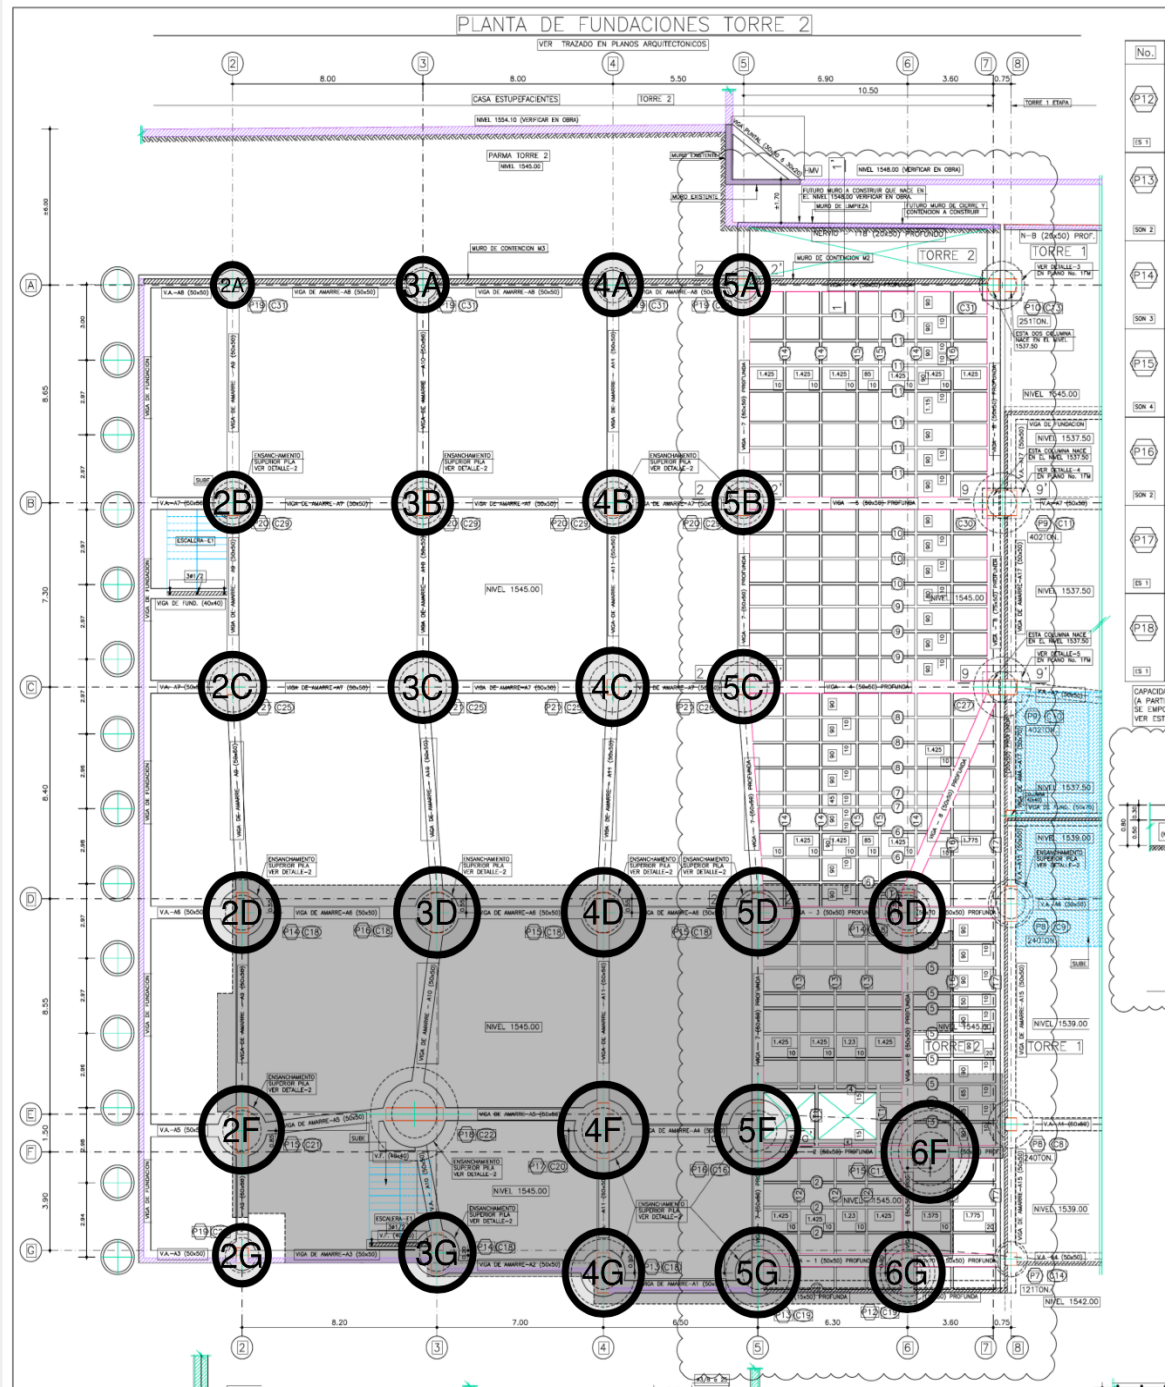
Nomenclatura plano estructural de la planta de fundaciones.
